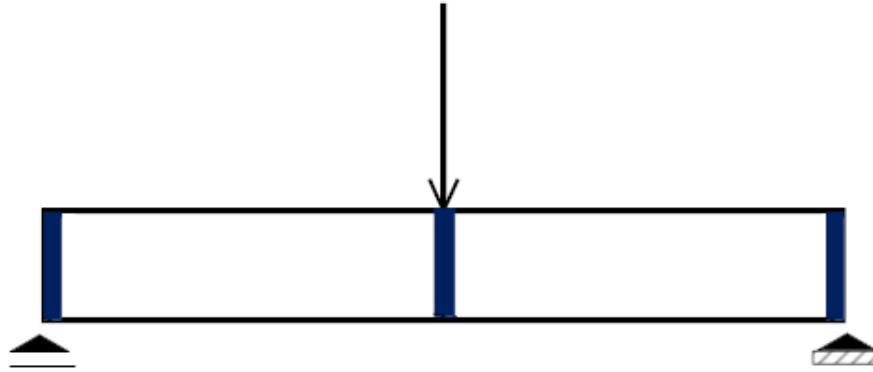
Desenho esquemático de viga com enrijecedores.
